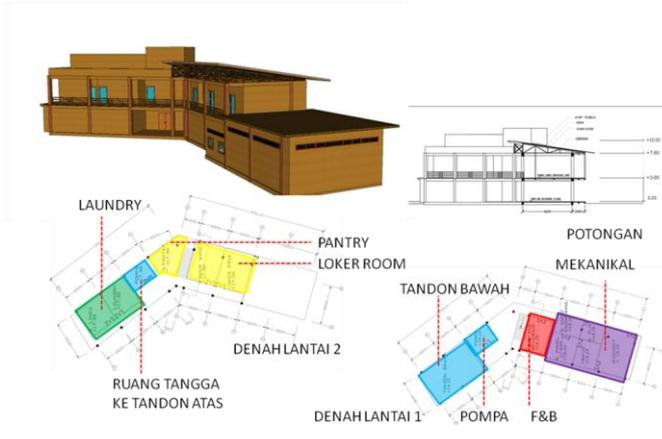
Perspektif dan Denah Massa Outbond
